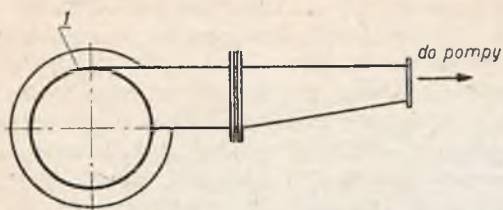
Przykłady układu pomp i przewodów na stacjach pomp
